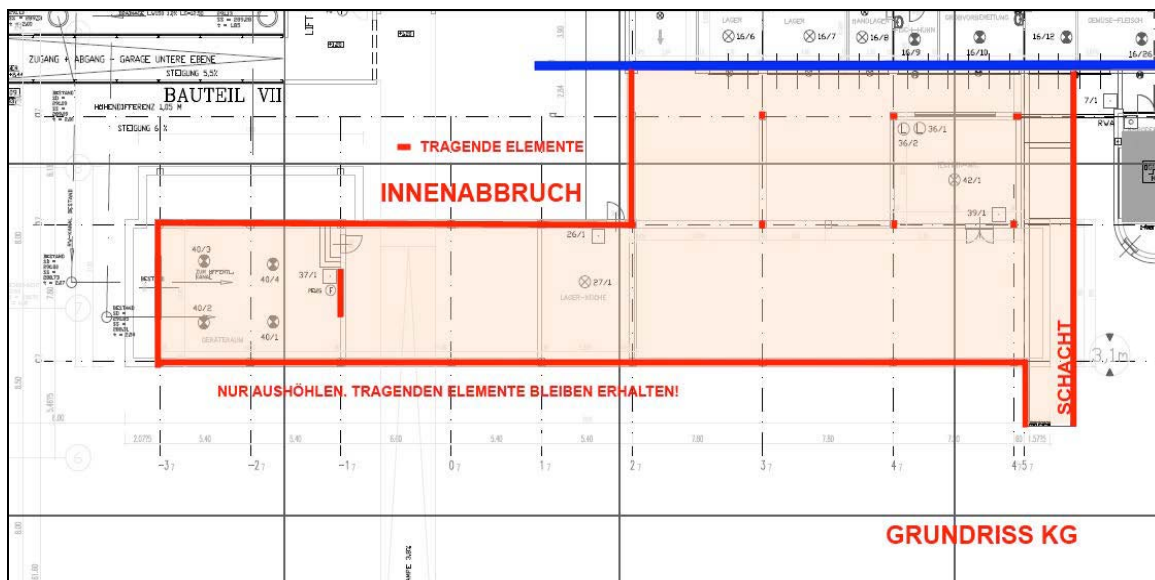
Abbruchkosten – LKH – Feldbach Bauteil VII Grundriss Kellergeschoss KG
